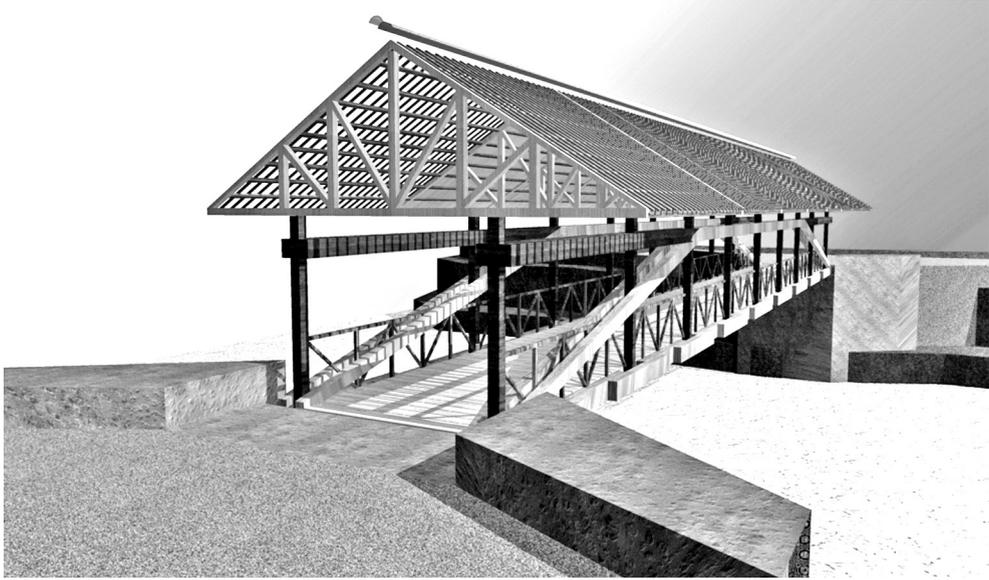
Reconstrucción virtual del puente sobre el río Guacaica, 1910.
